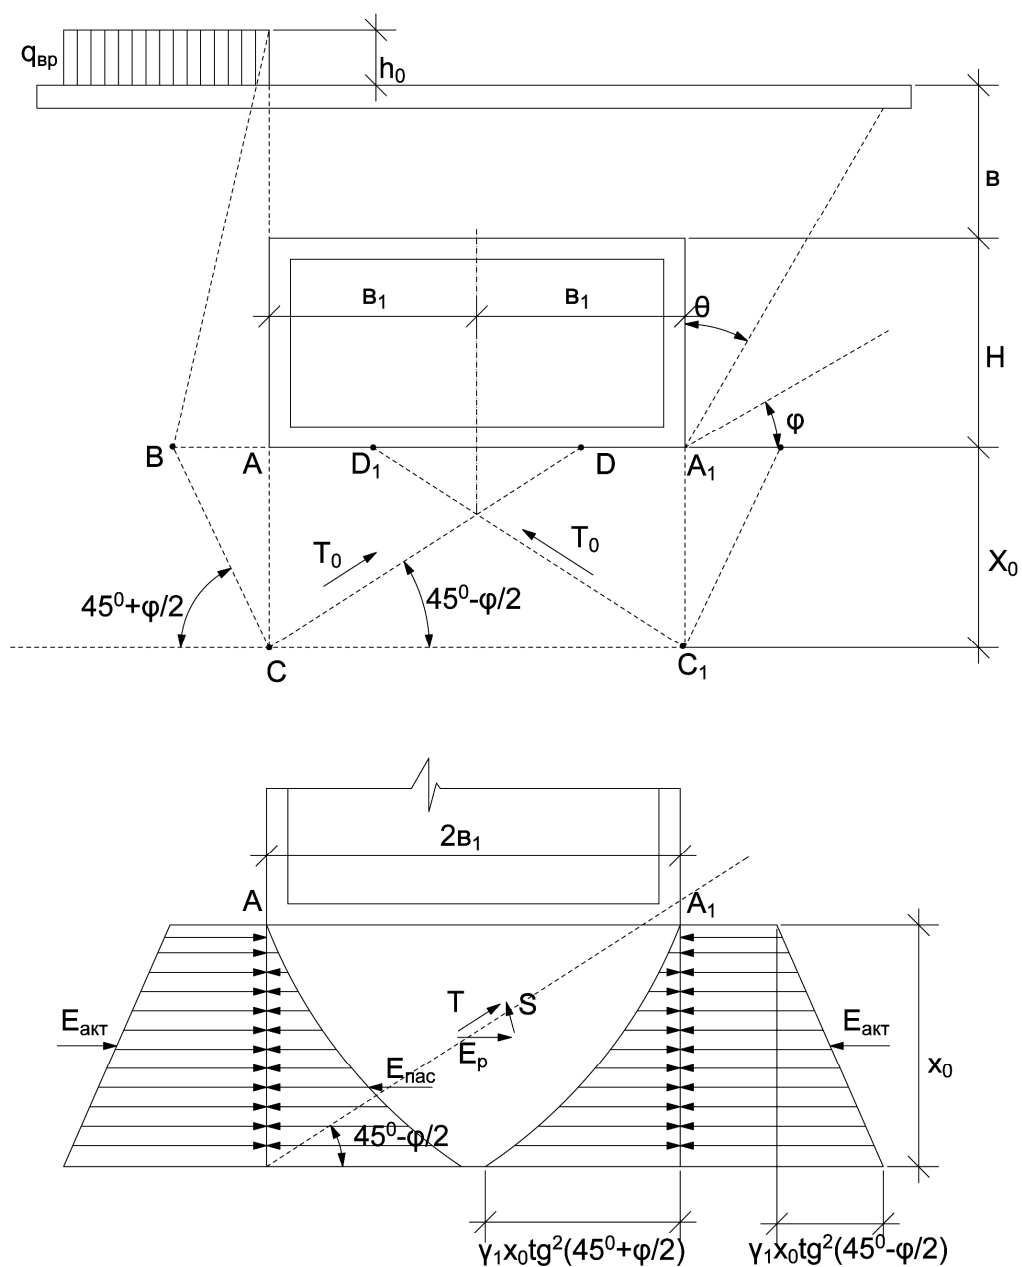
Расчетная схема к определению давления со стороны подошвы тоннеля
